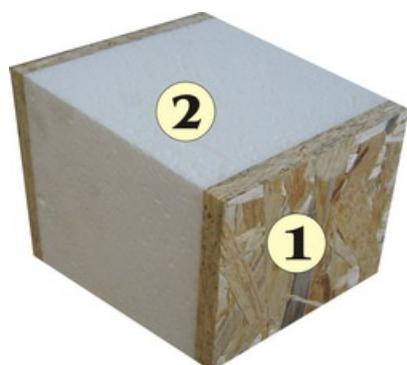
Конструкционная теплоизоляционная панель (СИП-панель)
